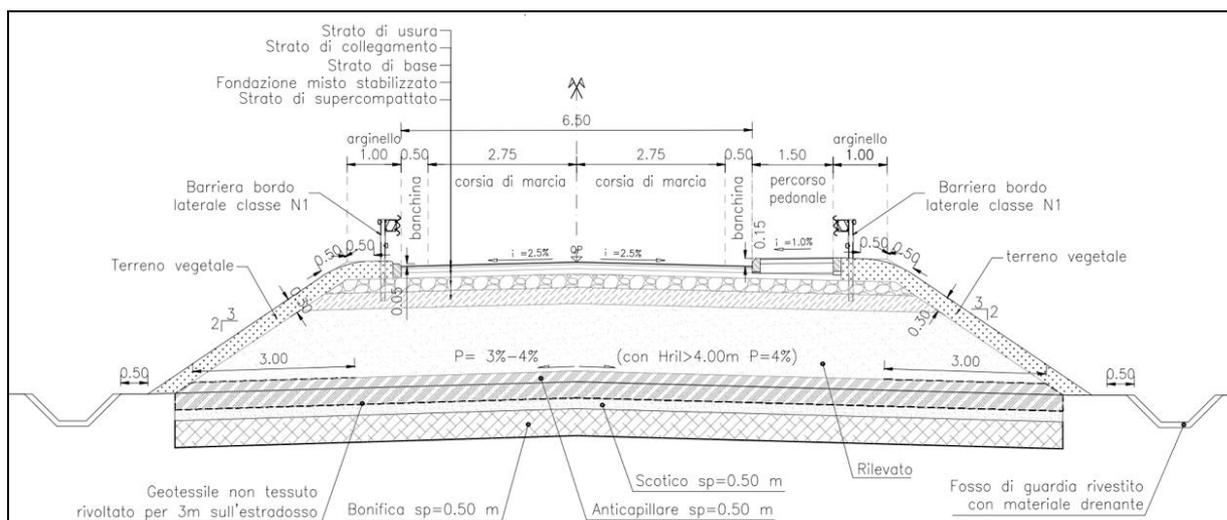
NV_ASSE 0: Via Argine sinistro - Sezione tipo in rilevato
